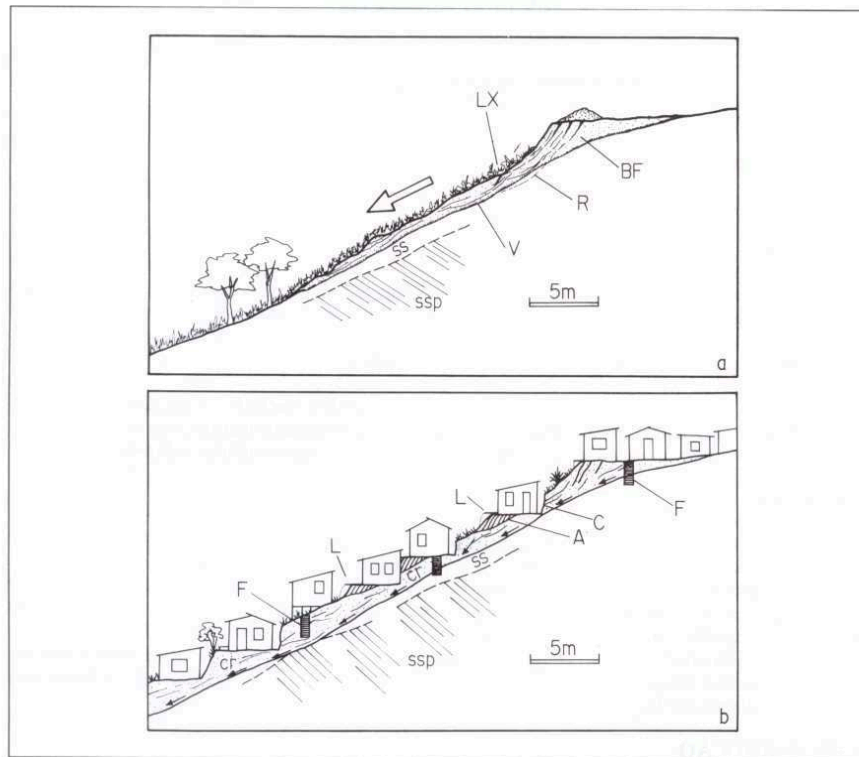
Perfil esquemático de instabilização de encostas ocupadas por moradias de baixo padrão construtivo em patamares de corte e aterro.
